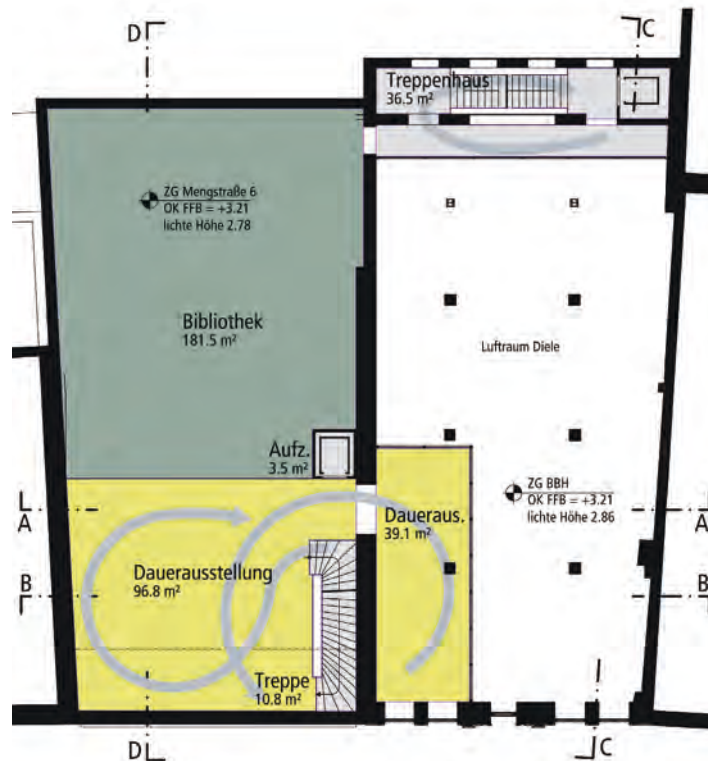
Variante 1, Grundriss Zwischengeschoss
